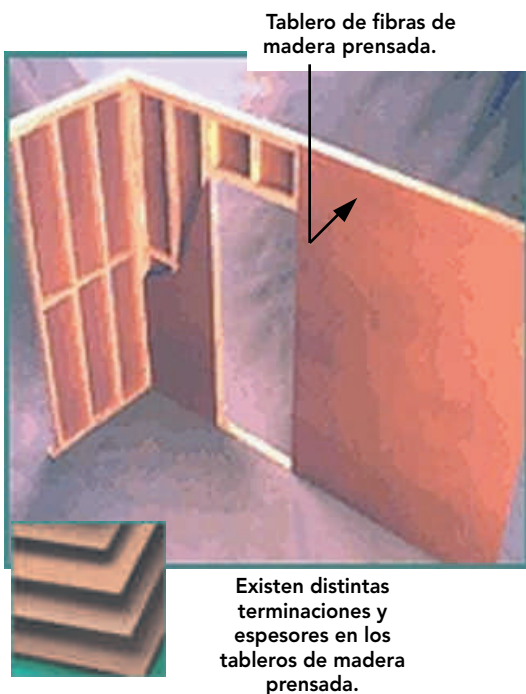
24: Revestimiento con paneles de madera prensada.
